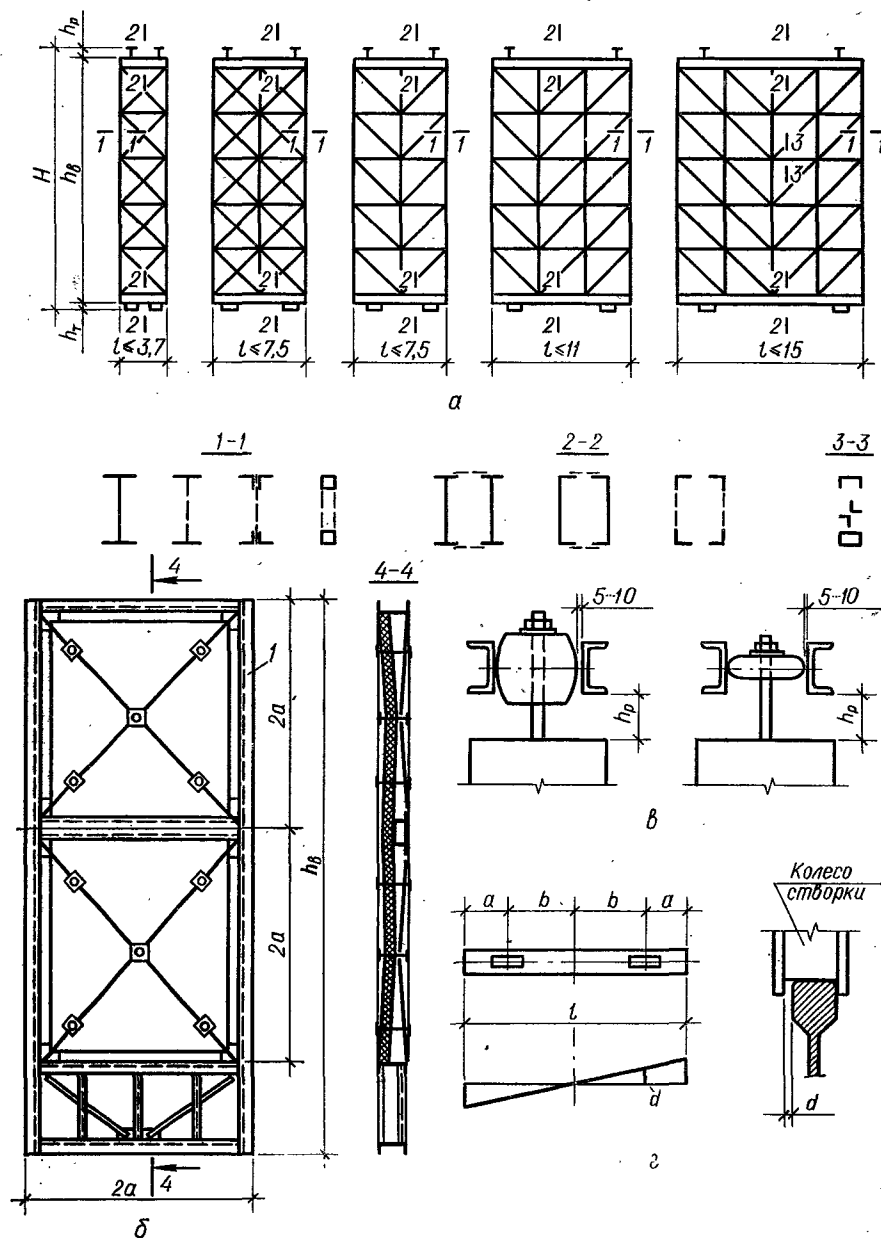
Схемы створок ворот большепролетных зданий: а — каркасных с обычными обшивками; б — с мембранными обшивками; в — типы верхних роликов; г — расположение нижних тележек.
